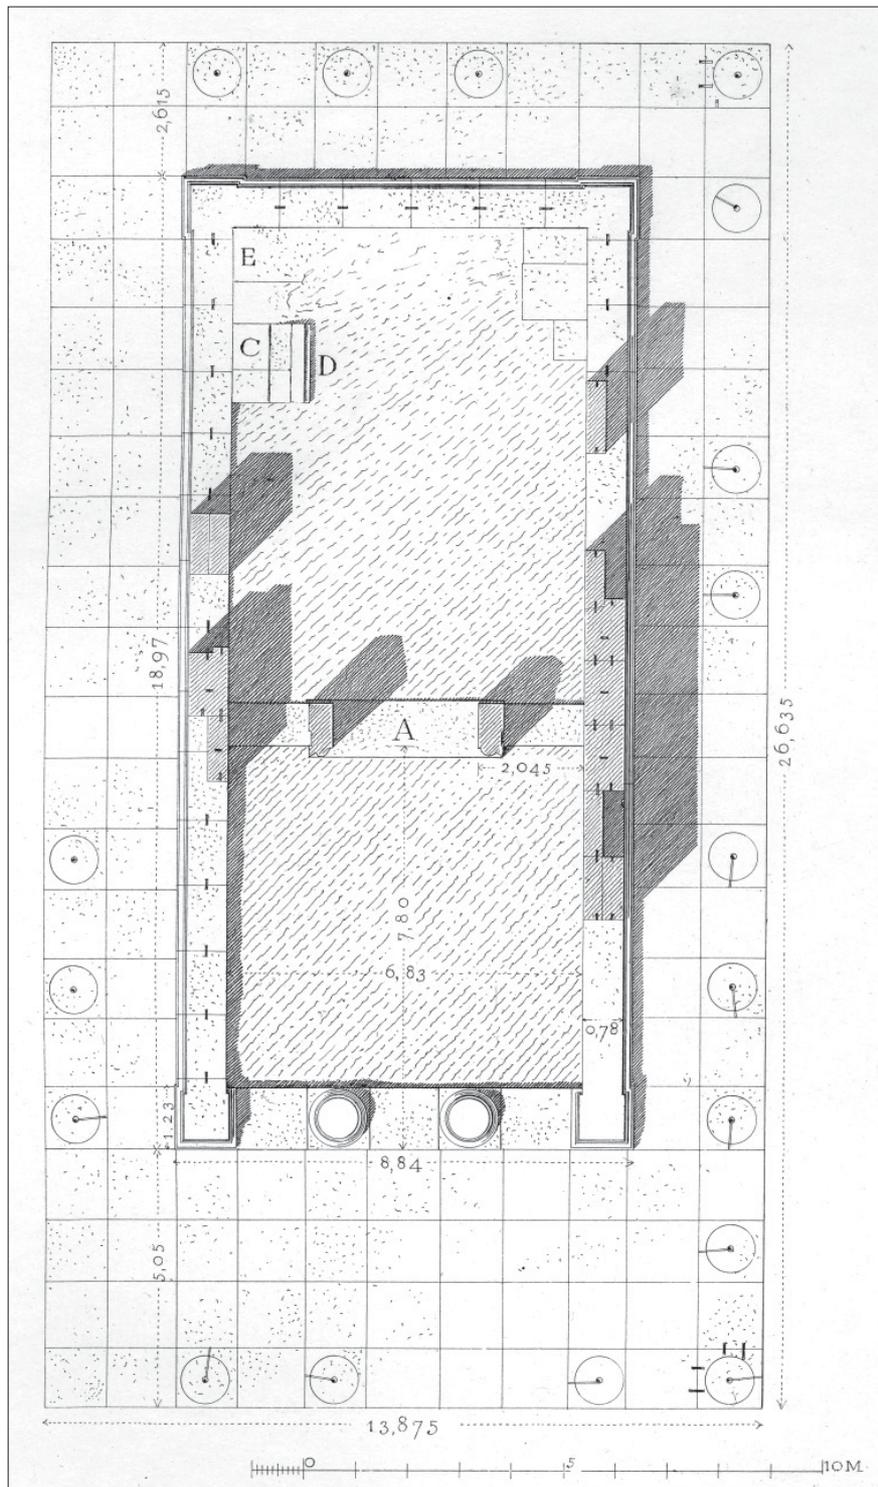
Grundrissplan des Kaisertempels von Sagalassos. – (Nach Lanckoroński 1892, Taf. 24).
